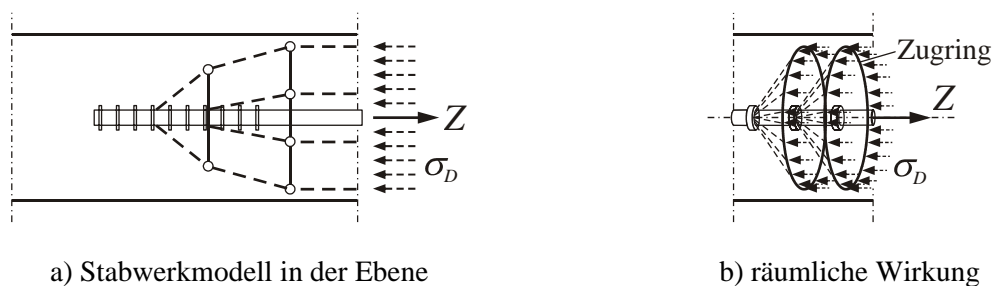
Stabwerkmodell eines mittig in einem Betonkörper verankerten Bewehrungsstabes aus SCHLAICH & SCHÄFER [92]
